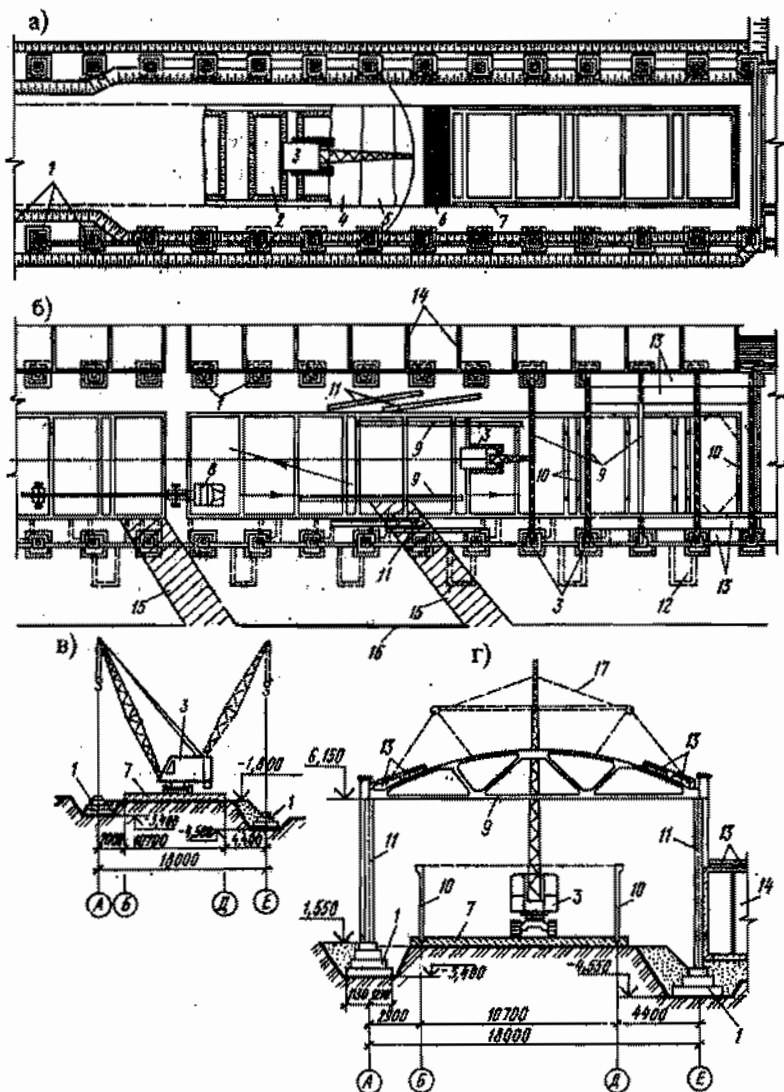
Схема монтажа здания фильтров водоочистной станции производительностью 200 тыс. м<sup>3</sup>/сут: 1 - фундаменты; 2 - приямки; 3 - гусеничный кран грузоподъемностью 20 т; 4 - бетонная подготовка; 5 - асфальт; 6 - арматурные сетки; 7 - монолитное днище; 8 - фермовоз; 9 - железобетонные фермы длиной 18 м; 10 - панели стен фильтров; 11 - колонны здания; 12 - колодцы; 13 - плиты покрытия; 14 - коридоры отстойника; 15 - съезды; 16 - временная автотора; 17 - траверса для монтажа ферм
